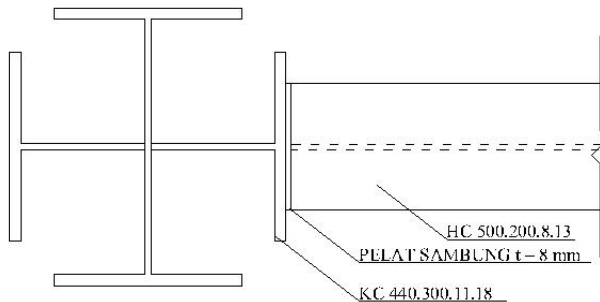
Detail sambungan balok indukatap – kolom
